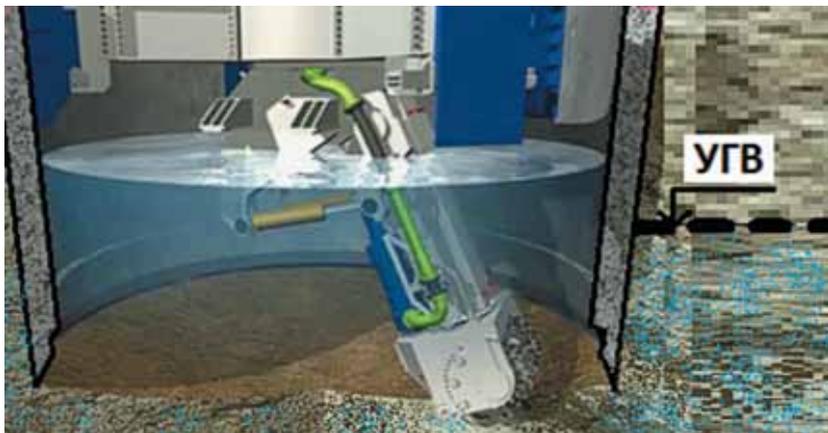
Схема разработки грунта стволотехнологической машиной под водой (начальный этап проходки с заполнением ствола водой выше уровня грунтовых вод)
